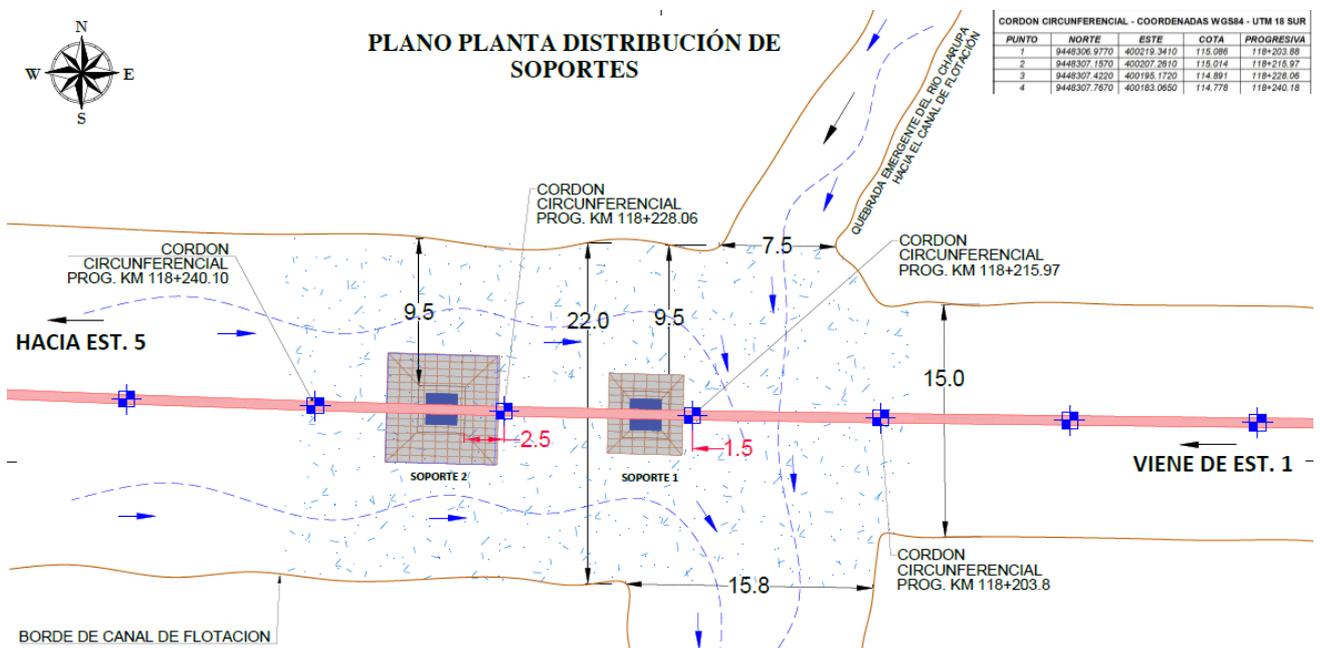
Planta donde se visualiza la ubicación de apoyos.
